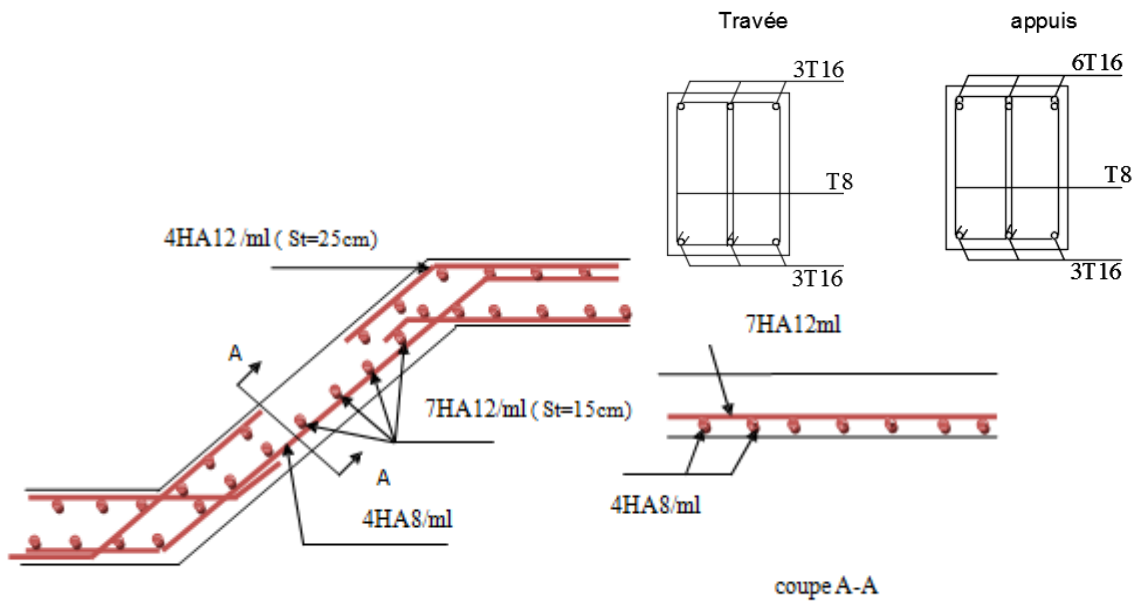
Disposition constructive des armatures des Escaliers à deux volées.
